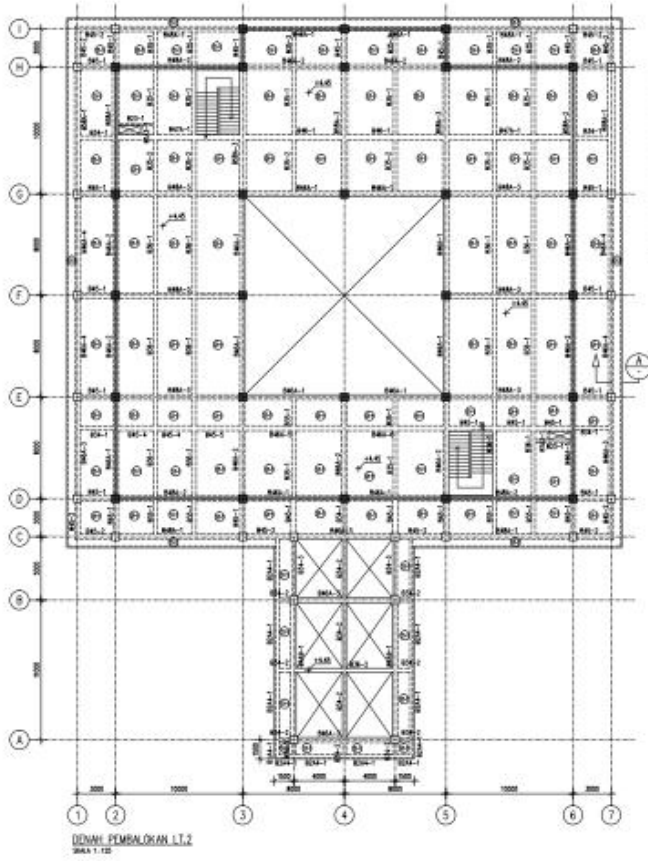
Denah Lokasi Kolom Lantai 2
